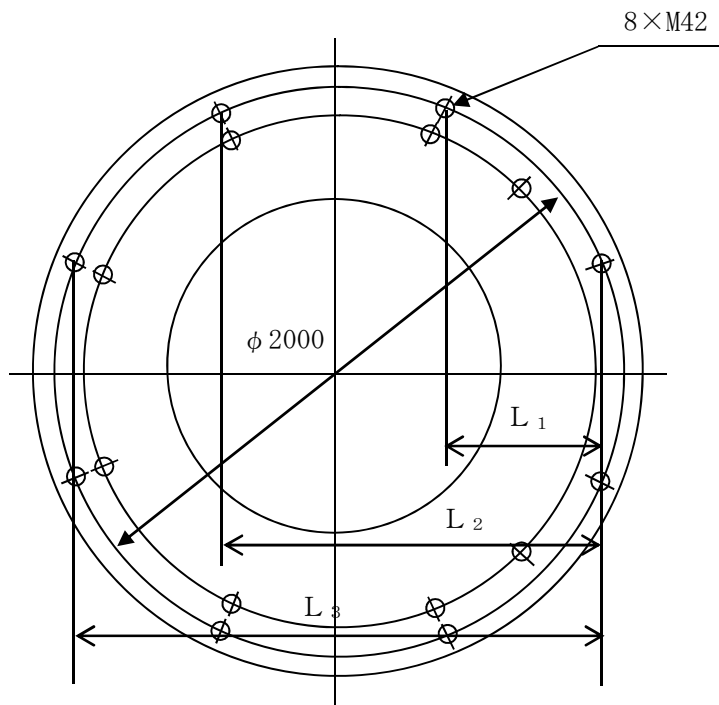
据付面基礎ボルトの各ボルト間寸法の配置図
